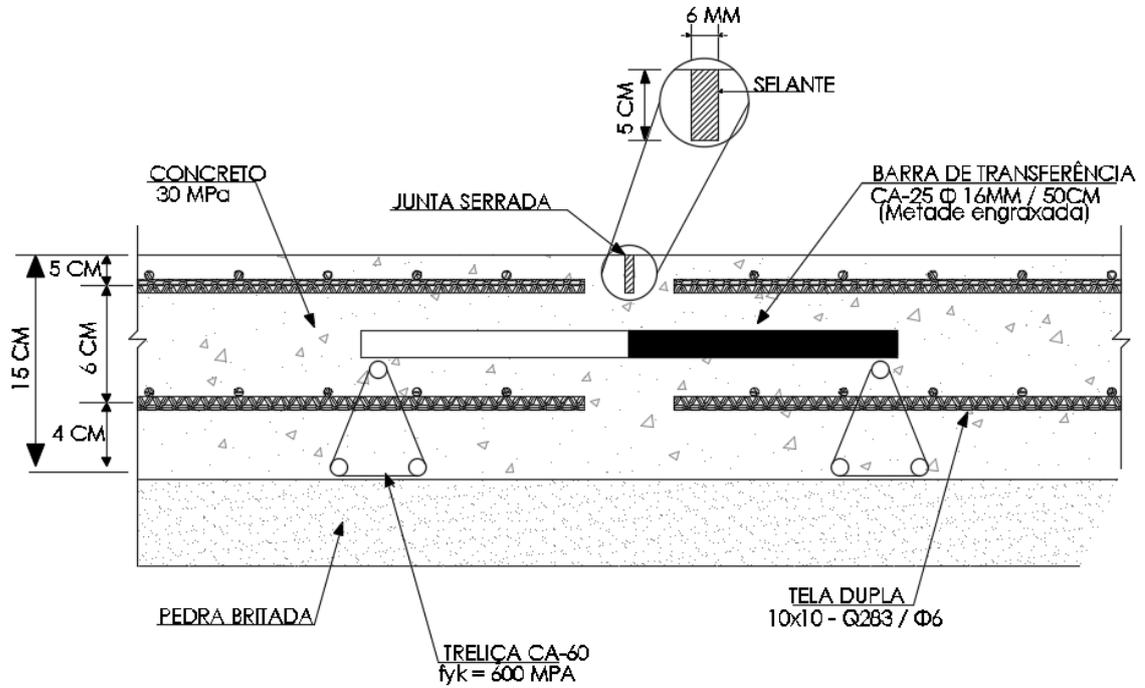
Detalhamento/Corte da calçada onde será colocado as barras de transferência.
